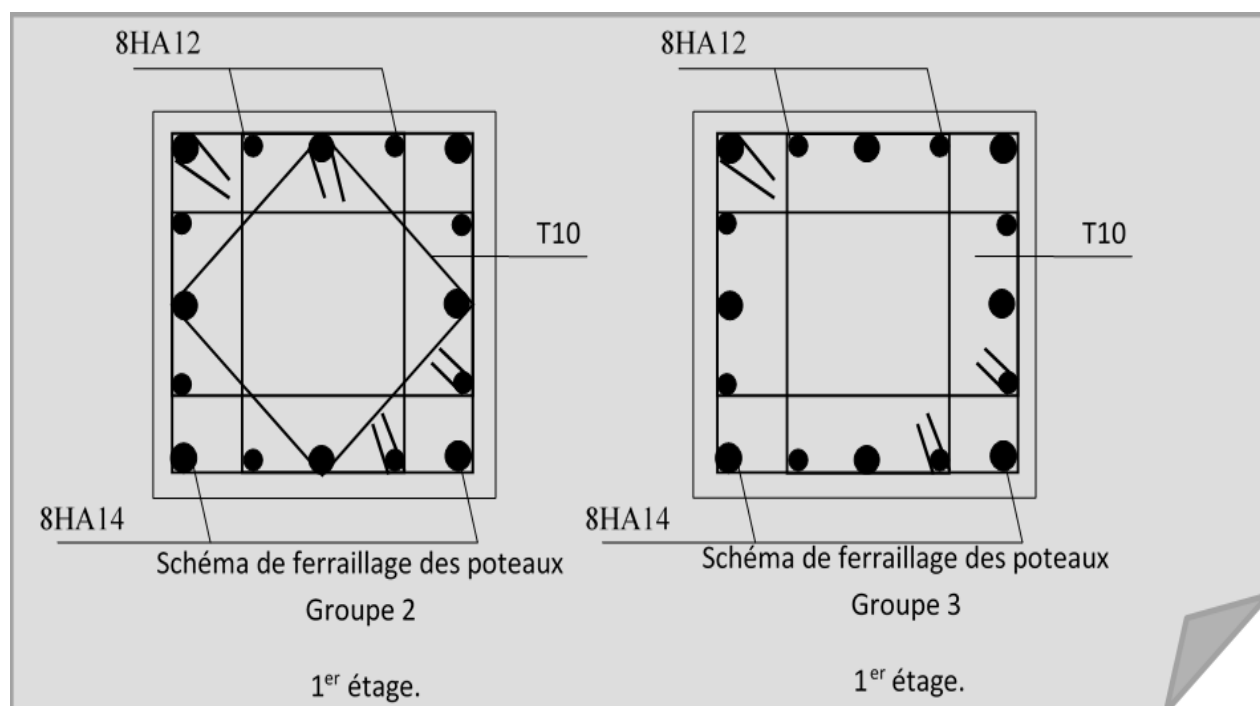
Schémas de ferrailage des poteaux 1^{er} étage.
